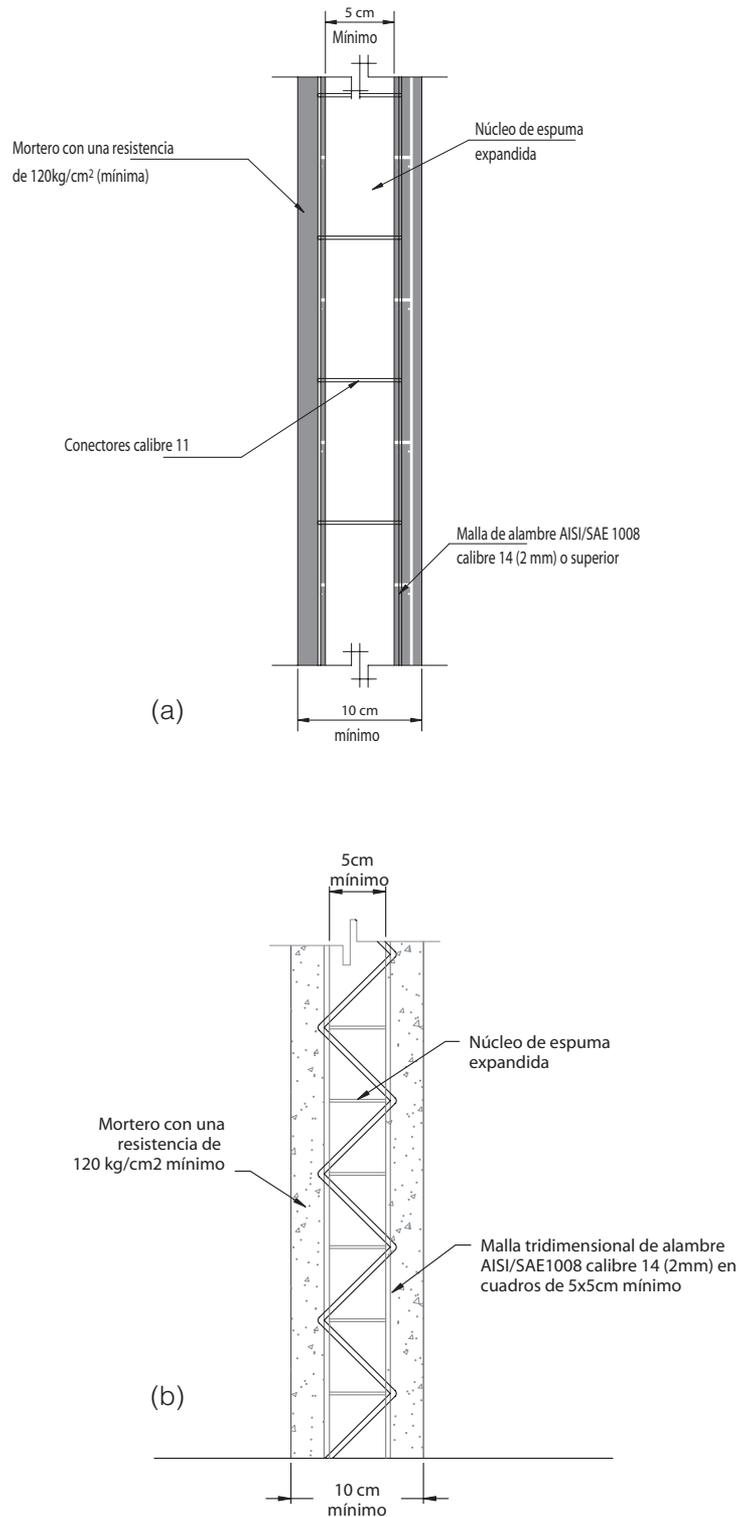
Detalles de posibles paredes tipo emparedado.
